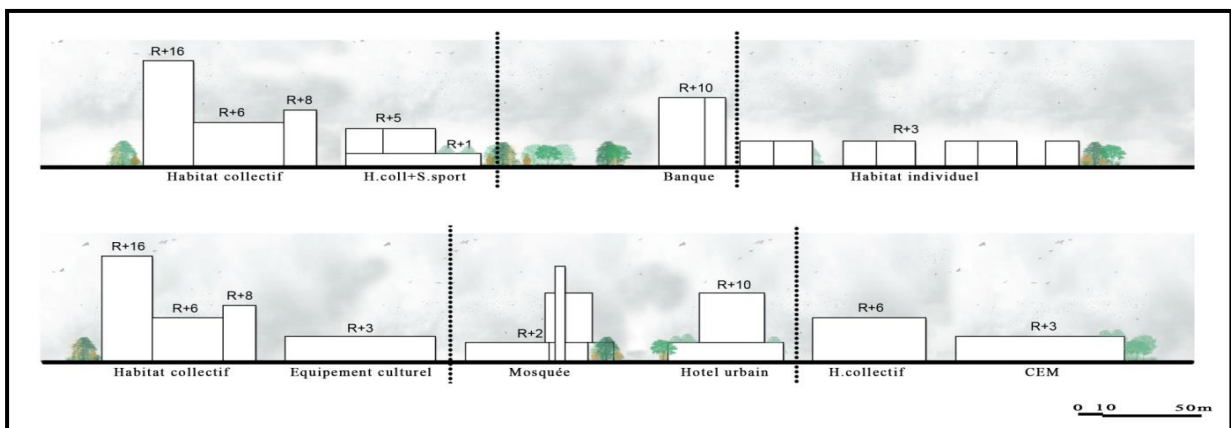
(IV.7) : des coupes transversales sur le boulevard
